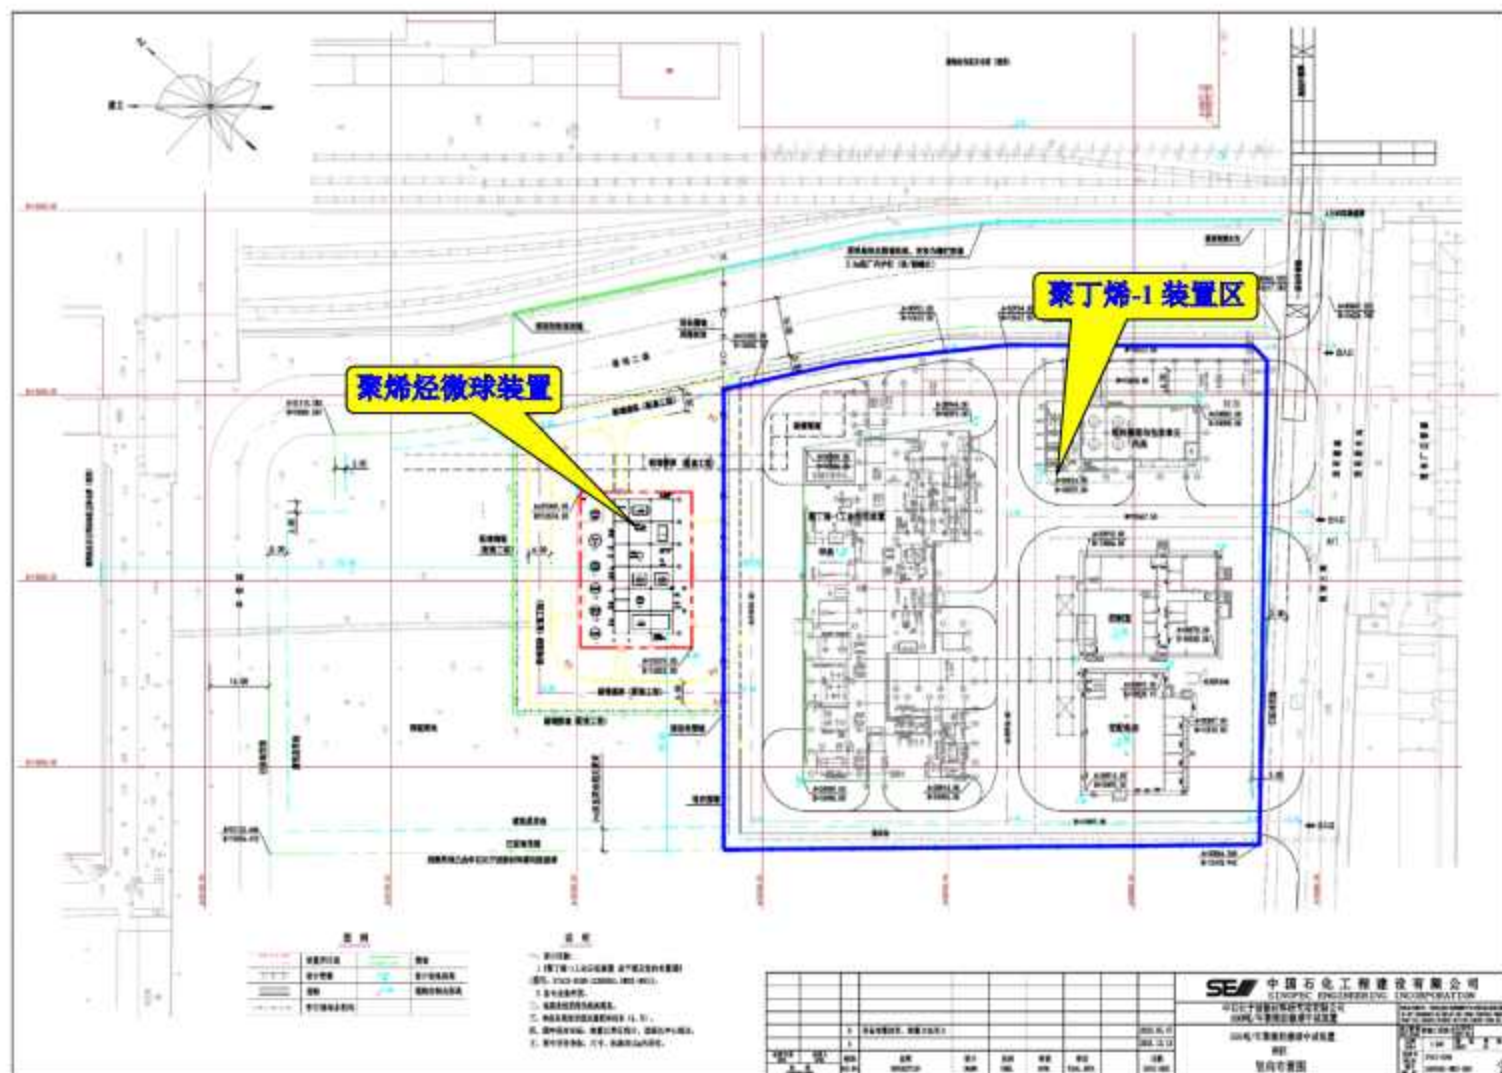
企业现有项目总平面布置图 (中试基地)
